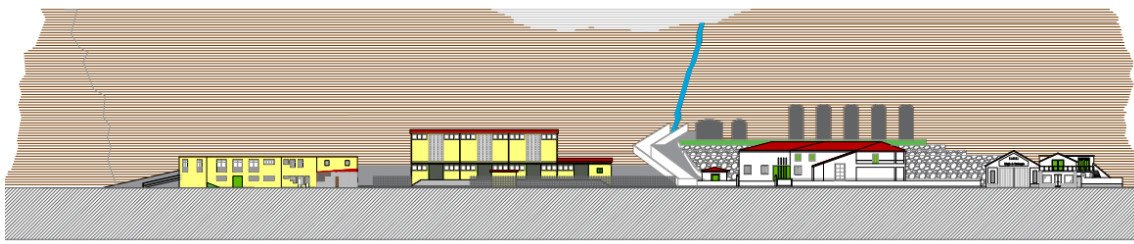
Planta de Caracterização: Alçado Nascente. [s/escala] (Anexo II, Desenho nº10)
